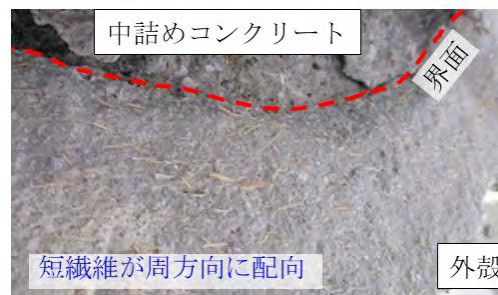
外殻の断面状況 (高さ 300 mm 位置)
